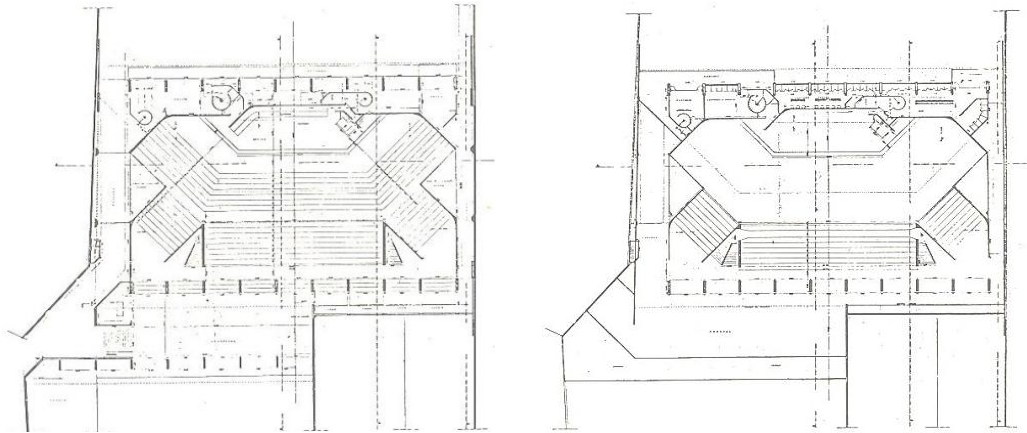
Planta baixa (esquerda) e mezanino (direita) da Igreja Evangélica.
